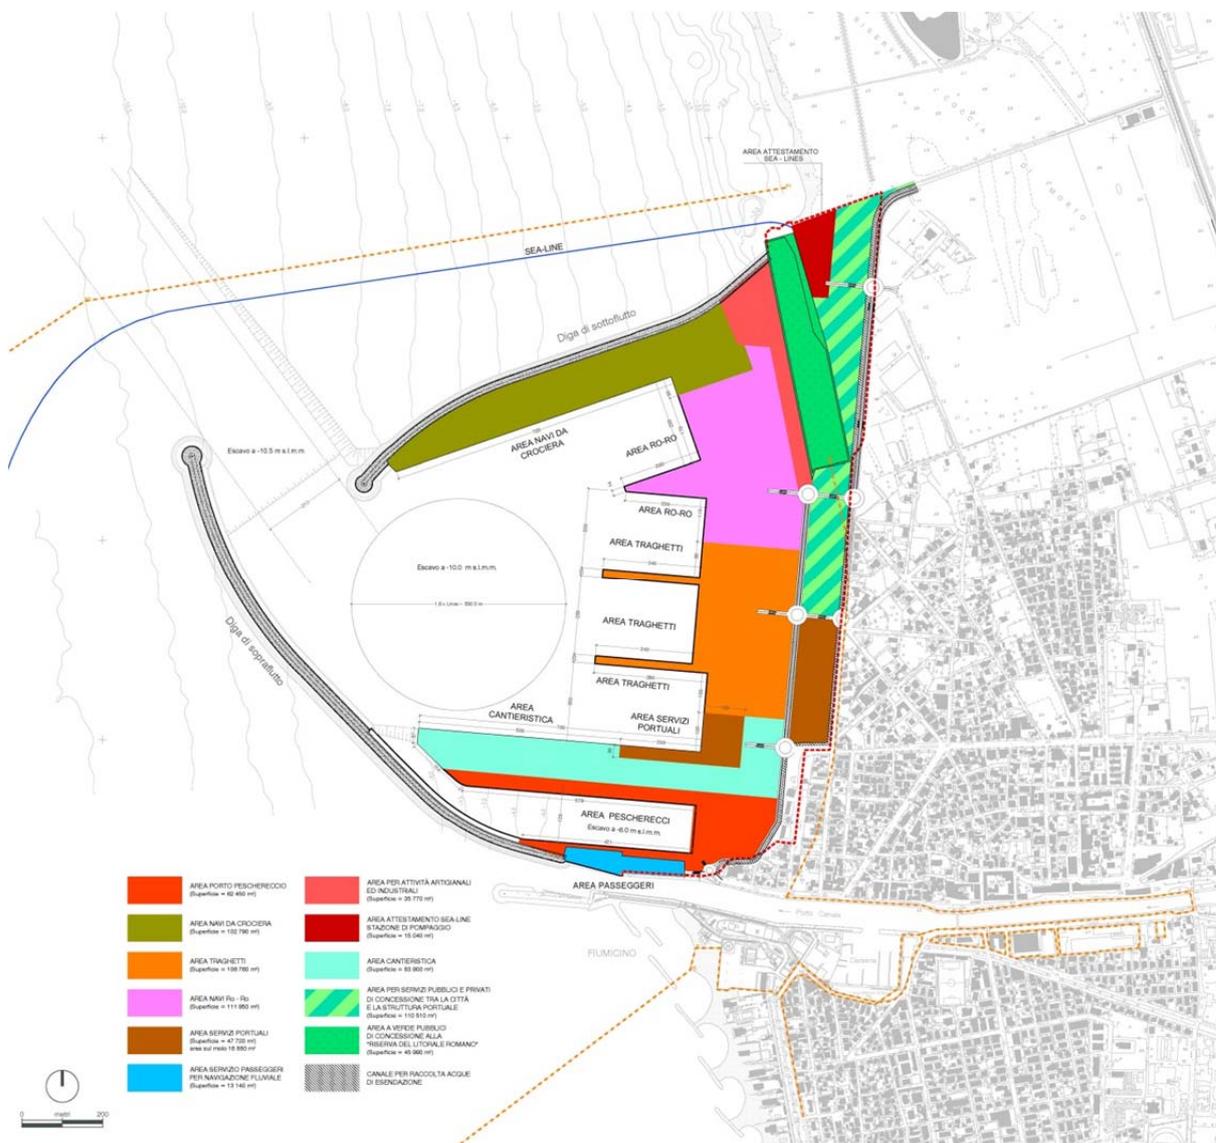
Planimetria del P.R.P. vigente con ottimizzazione della localizzazione della funzione crociere
